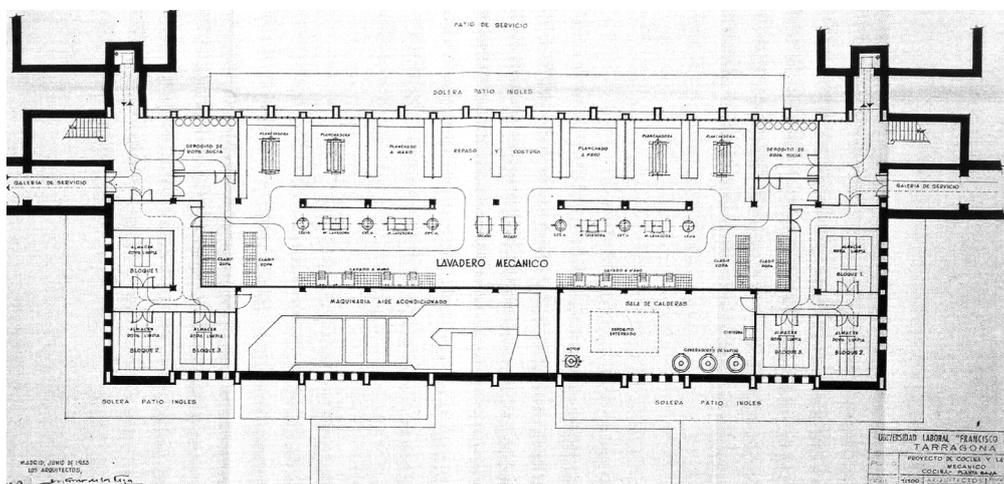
PLANTAS DE DISTRIBUCIÓN
